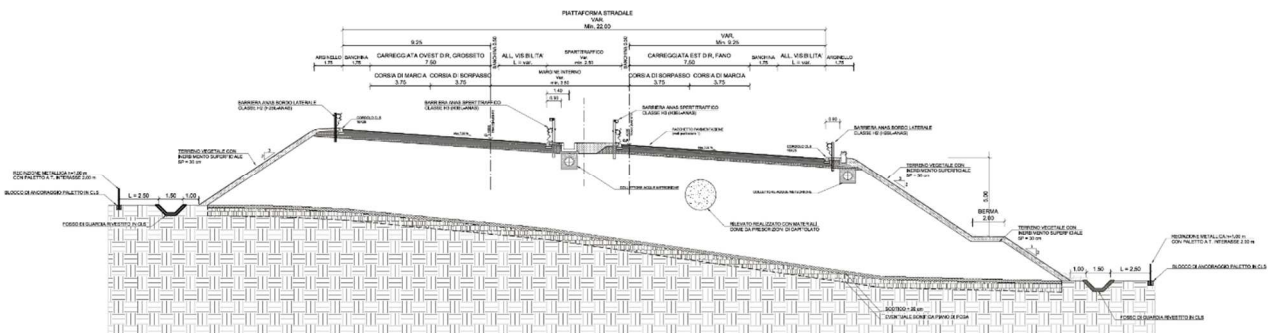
Sezione tipo in rilevato in curva con allargamento
